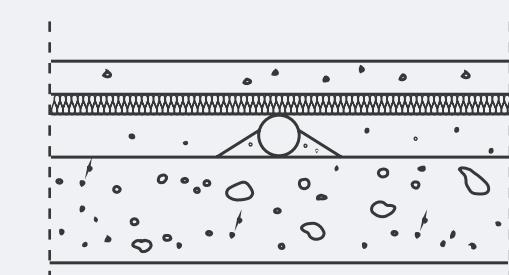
Modalità di realizzazione corretta di un pavimento galleggiante.
